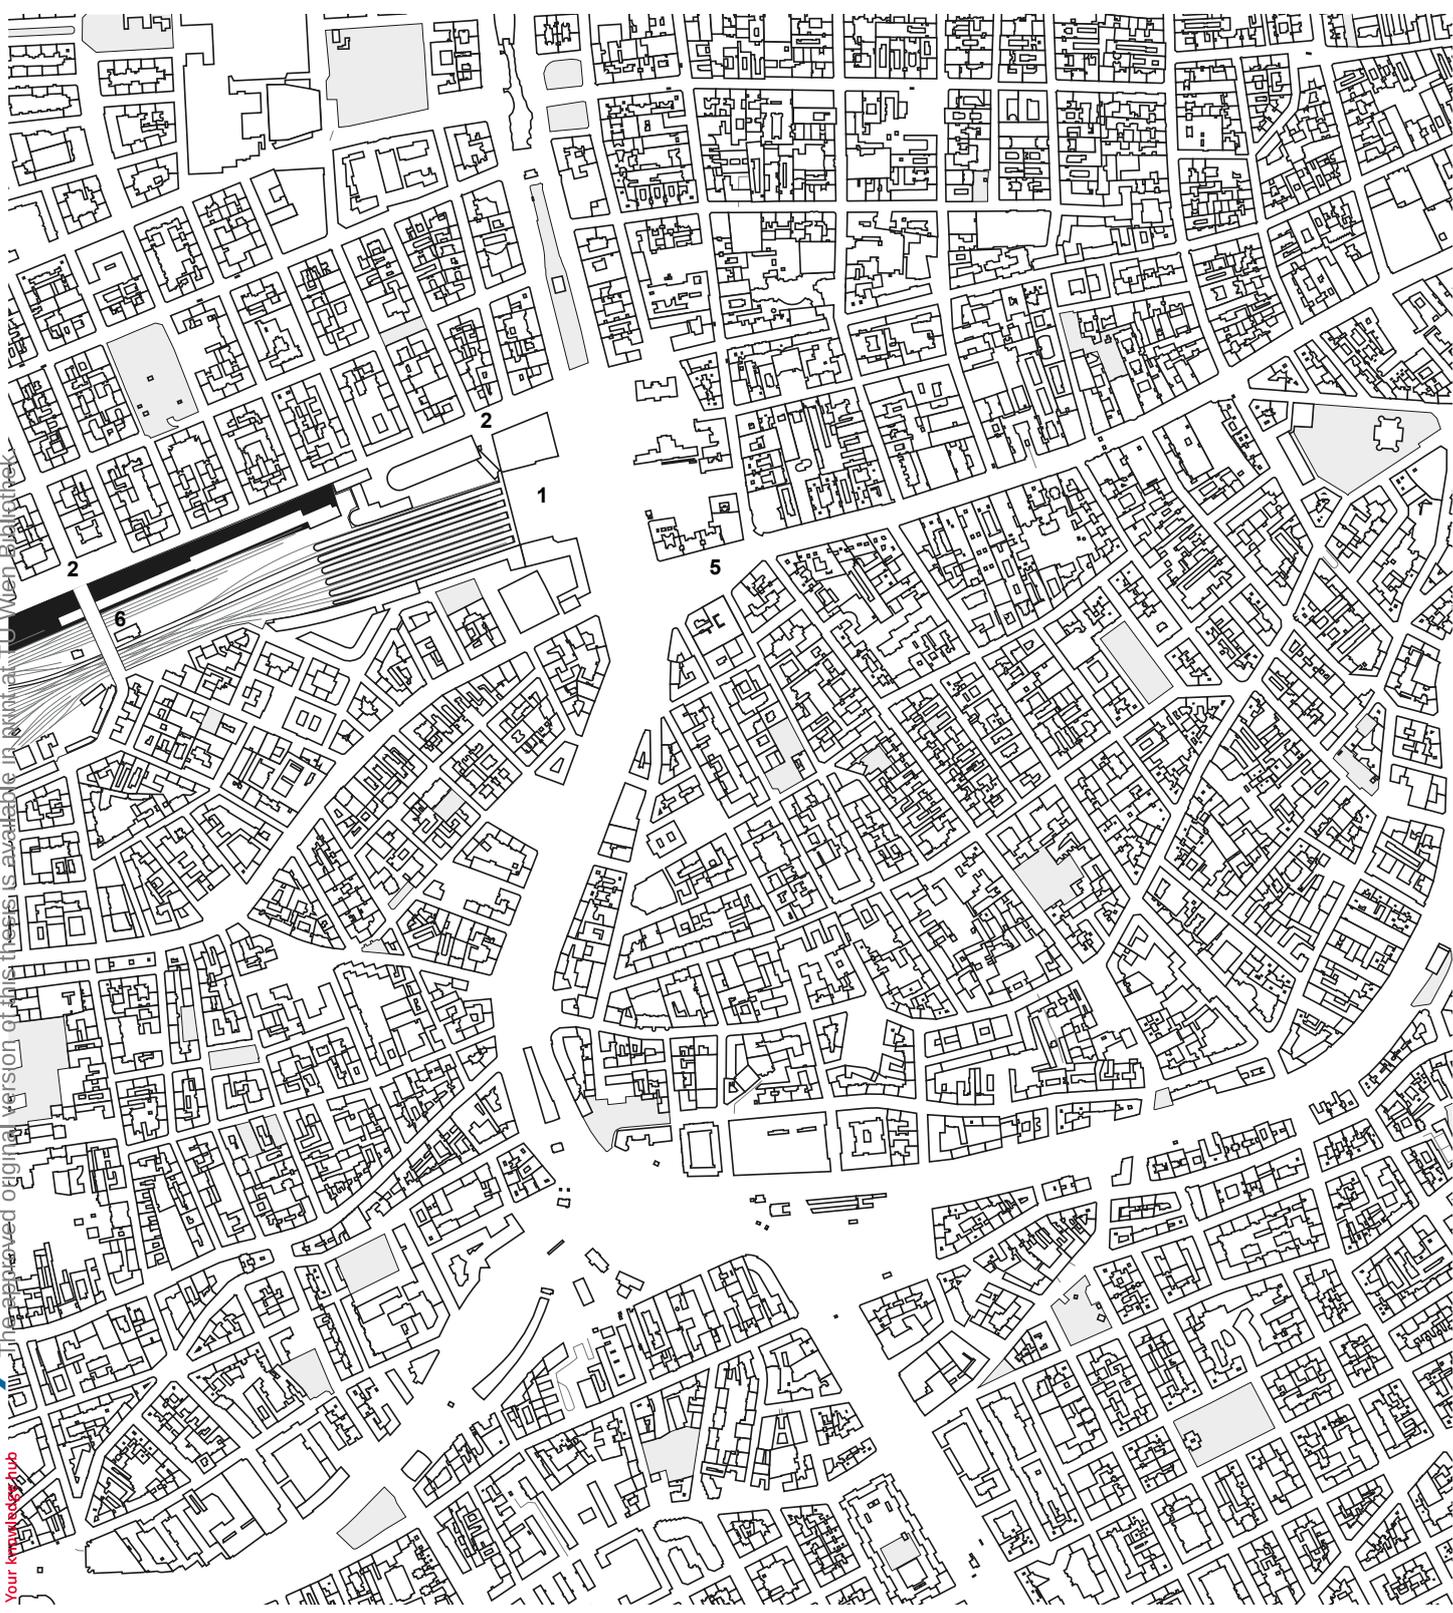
Lageplan Westbahnhof Areal, M 1:100.000
